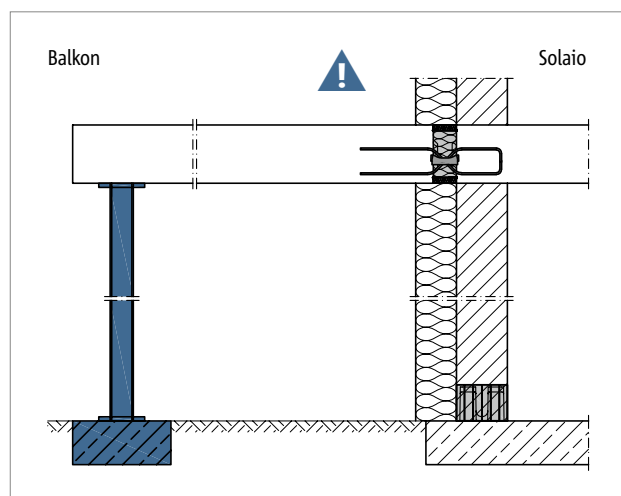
Schöck Isokorb® T tipo Q-VV: è necessario un appoggio continuo
